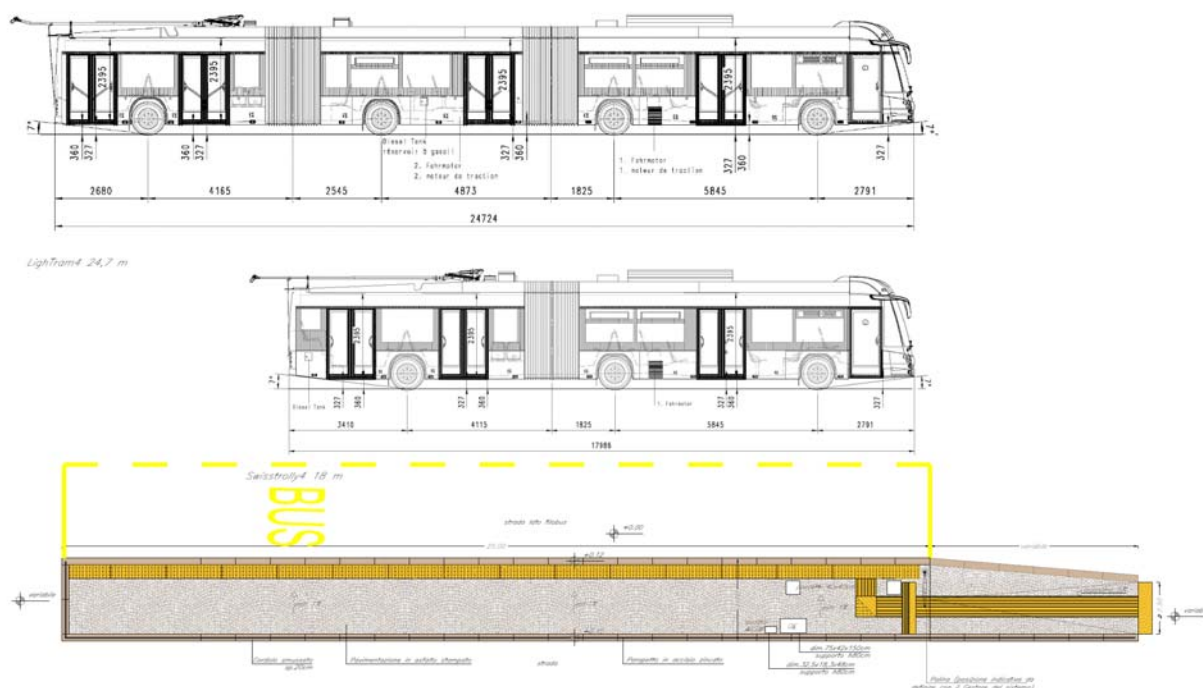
Pianta tipo banchina con ingombro mezzi da 18 (e 24,72 m opzionale)
